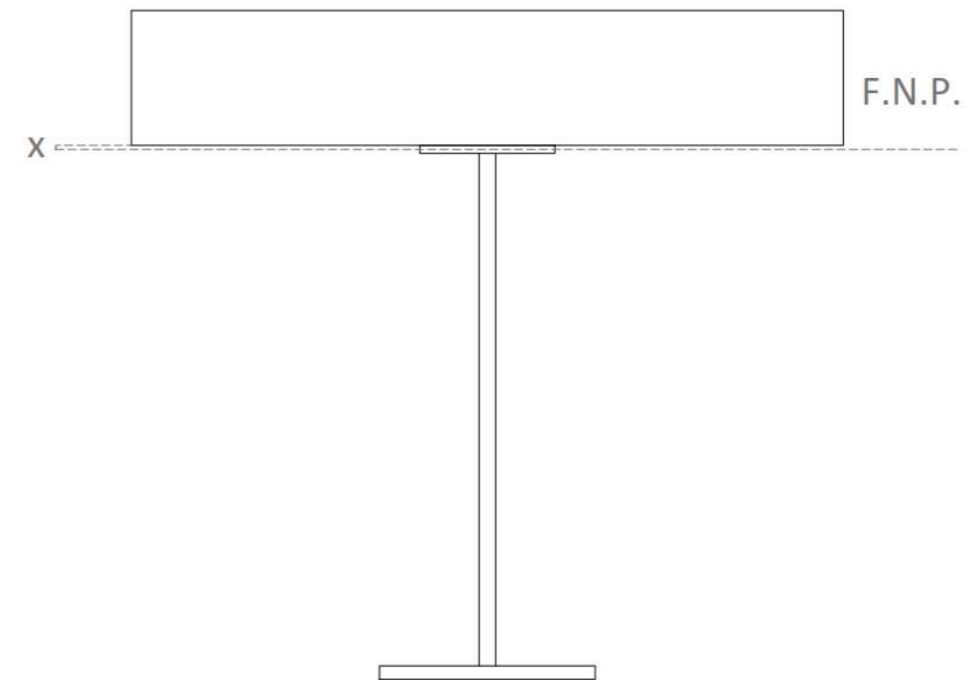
Fibra neutra plástica en el ala superior de la viga transversal (fuente: elaboración propia)
